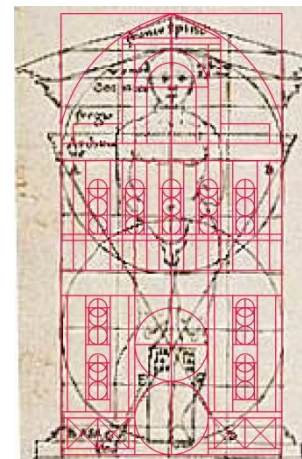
Esquema de fachada sobre fachada de Giorgio Martini.
